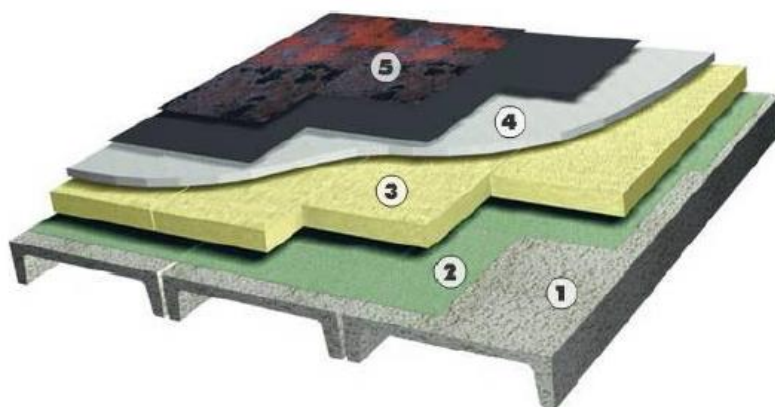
Структура плоской кровли: 1 – плиты покрытия; 2 – слой пароизоляции; 3 – слой утеплителя; 4 – железобетонная стяжка; 5 – слой гидроизоляции (рулонной или наплавляемой)
